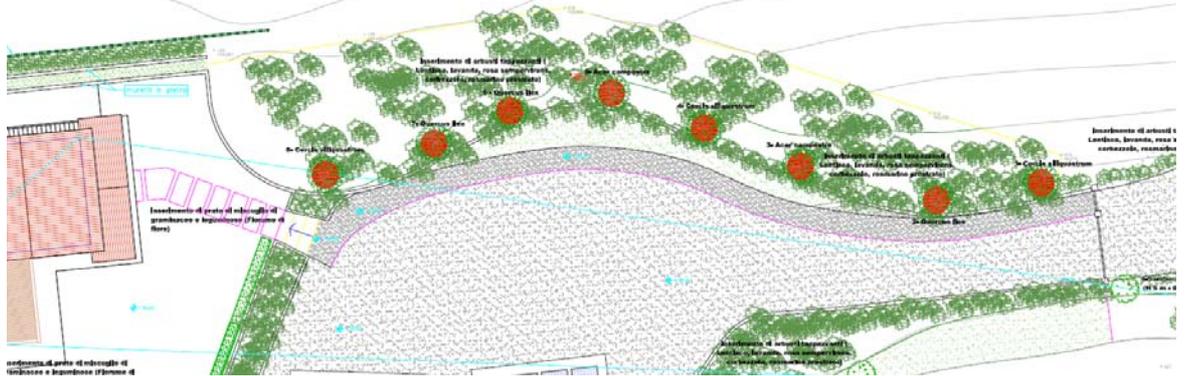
stralcio della Tav. A05b Planimetria Generale – Stato di Progetto – del luglio 2018.
